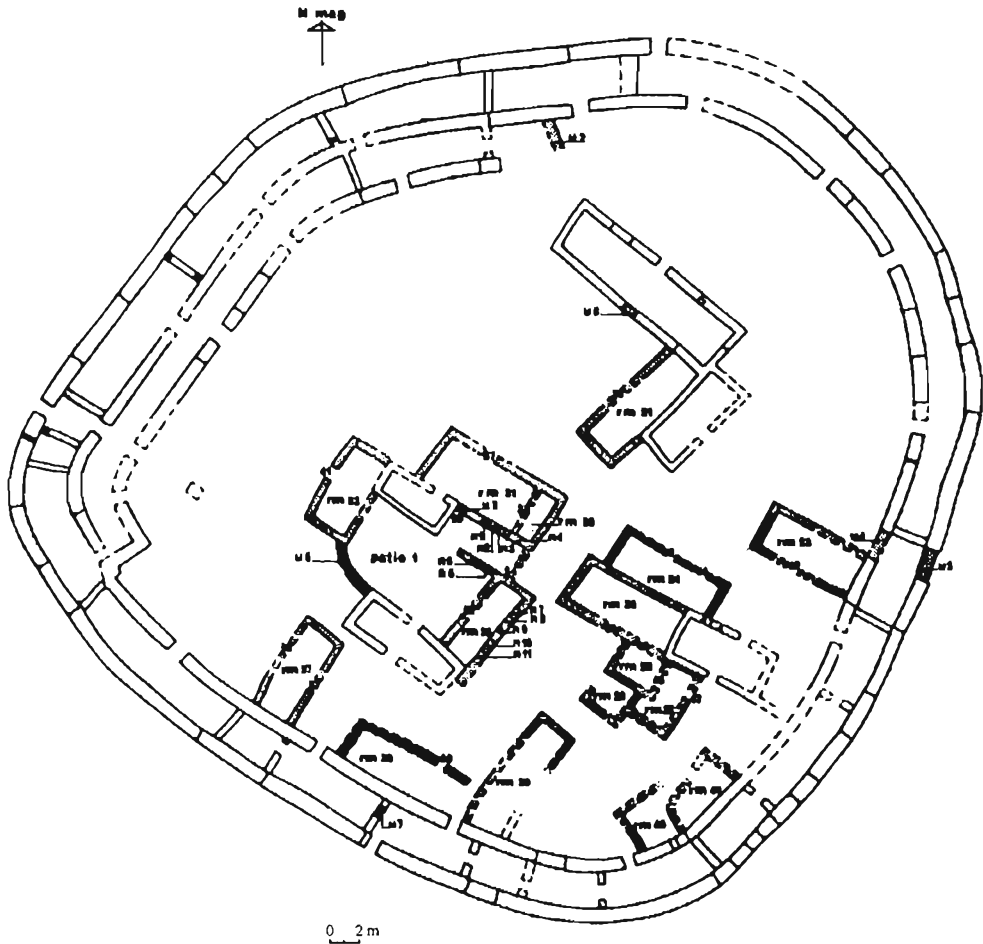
Plano detallado de una galería circular ubicada en Cerro de las Monjas. Los muros de las galerías fueron construidos en segmentos verticales y las juntas entre segmentos están marcadas en el plano (de Loten 1987: Fig. 17).
